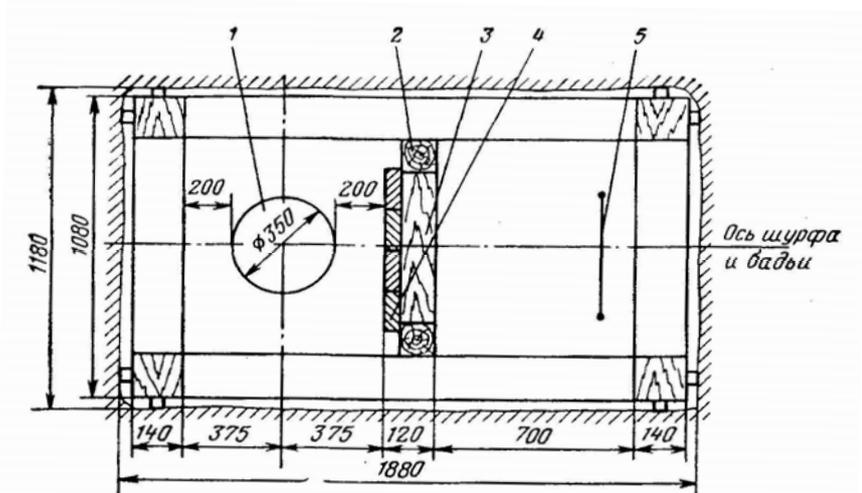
Типовое прямоугольное сечение шурфа с венцовой крепью:
